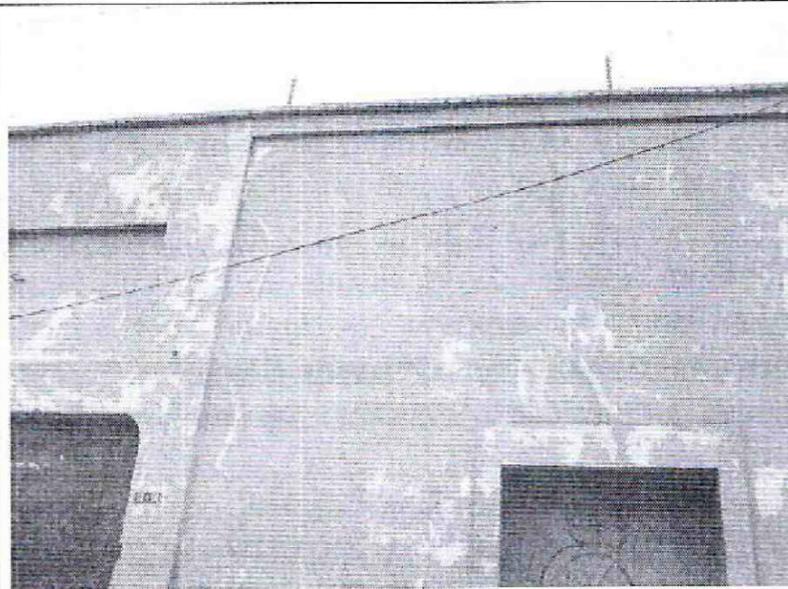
Grietas en la parte alta del extremo oriental.
